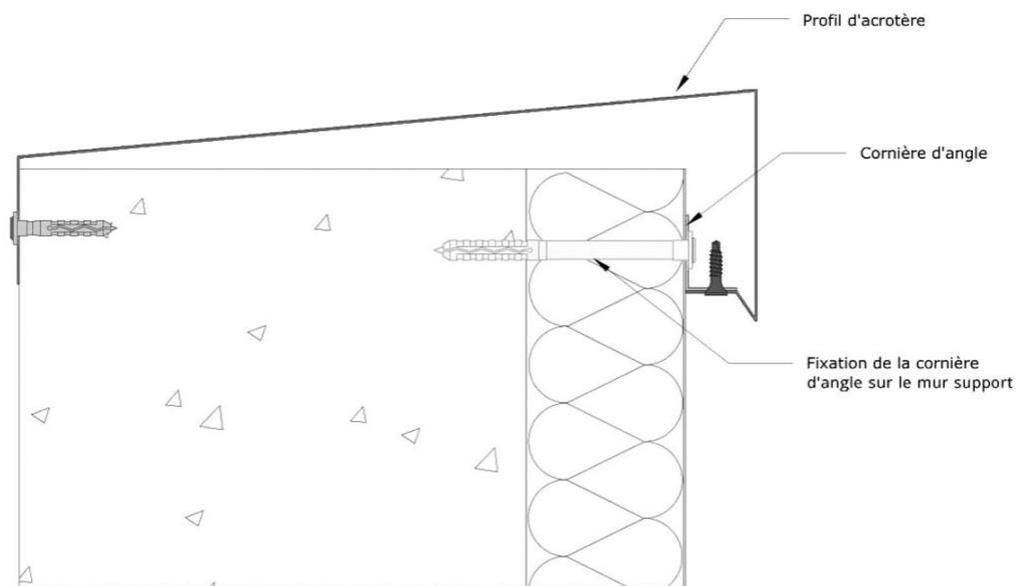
Haut de façade – Pose en vêtage (coupe verticale)
